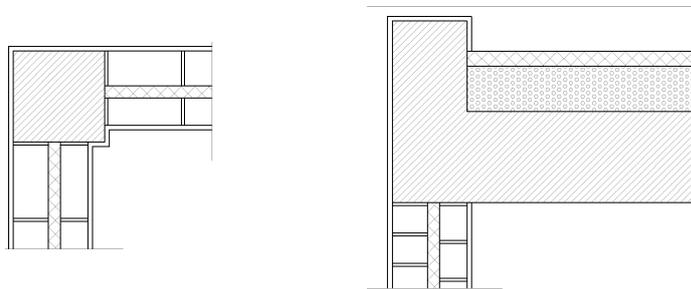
Ejemplos de puentes térmicos: Pilar integrado en fachada y cubierta con fachada
